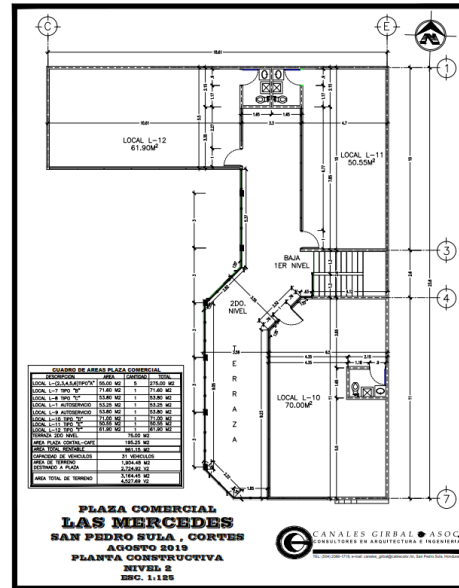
Planta constructiva Plaza Las Mercedes nivel2
